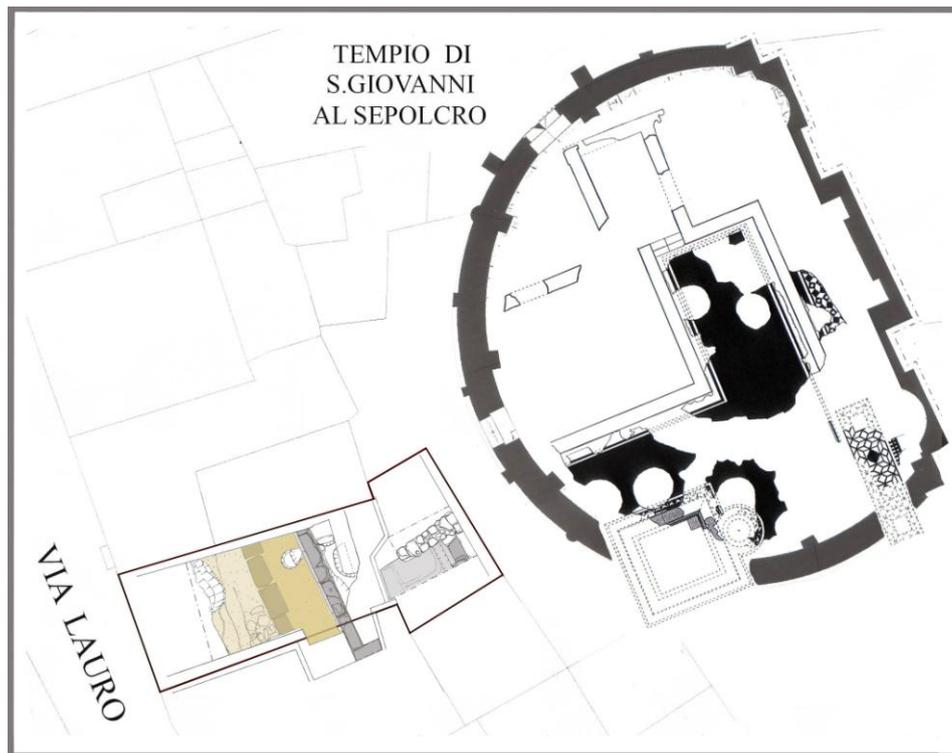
Planimetria generale con ubicazione dell'asse stradale e delle strutture e pavimenti musivi della domus rinvenuta al di sotto del tempio di S. Giovanni al Sepolcro e al piano terra dello stabile in Via Lauro 32.
